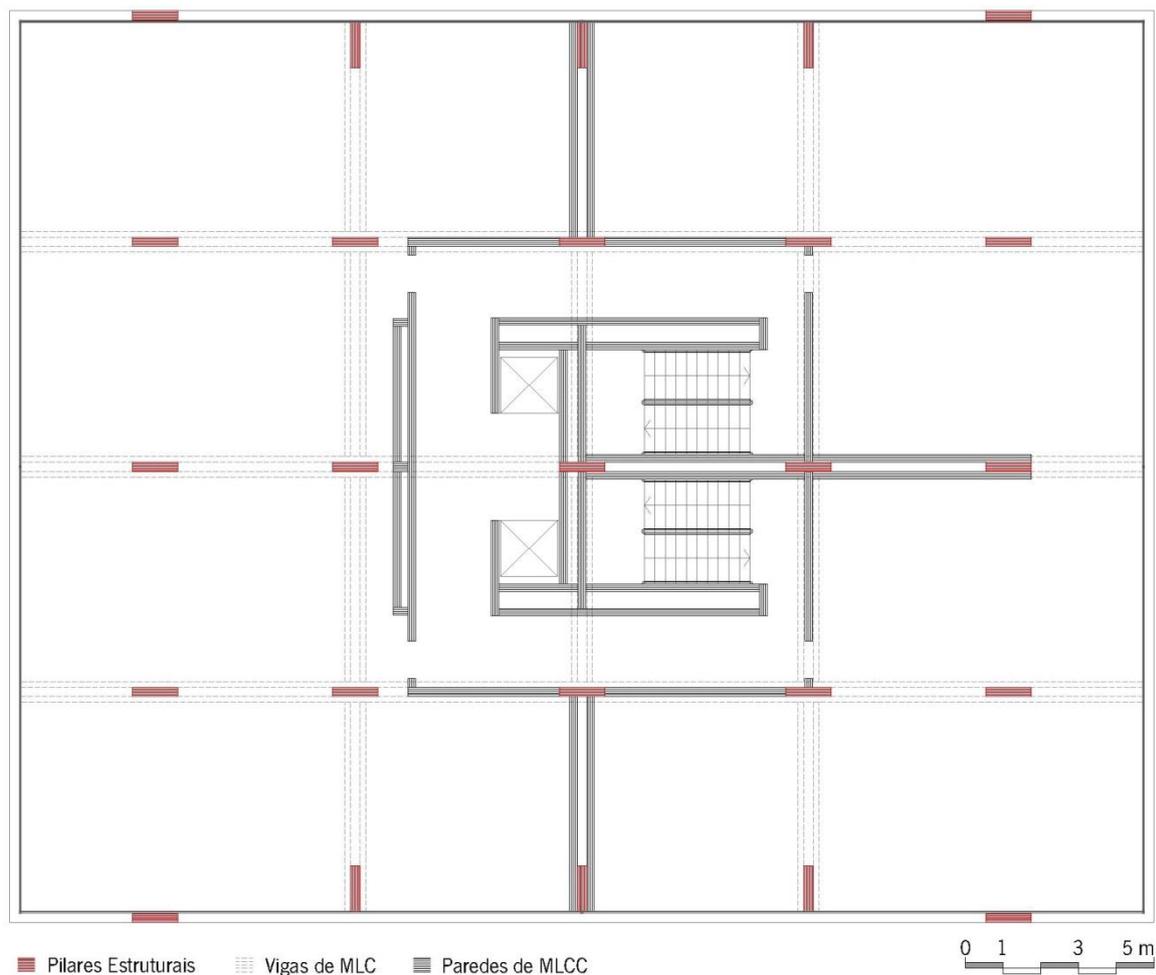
Planta de um Piso-Tipo do Edifício Proposto
